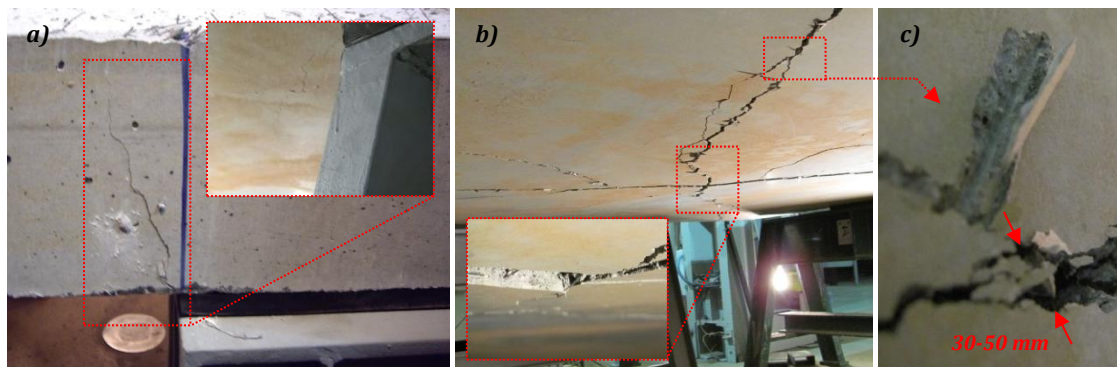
a) Fisuras llegando hasta los extremos de los apoyos; b) y c) detalle de la fisuración en la zona central de la losa L_B_3,0mx3,0m
